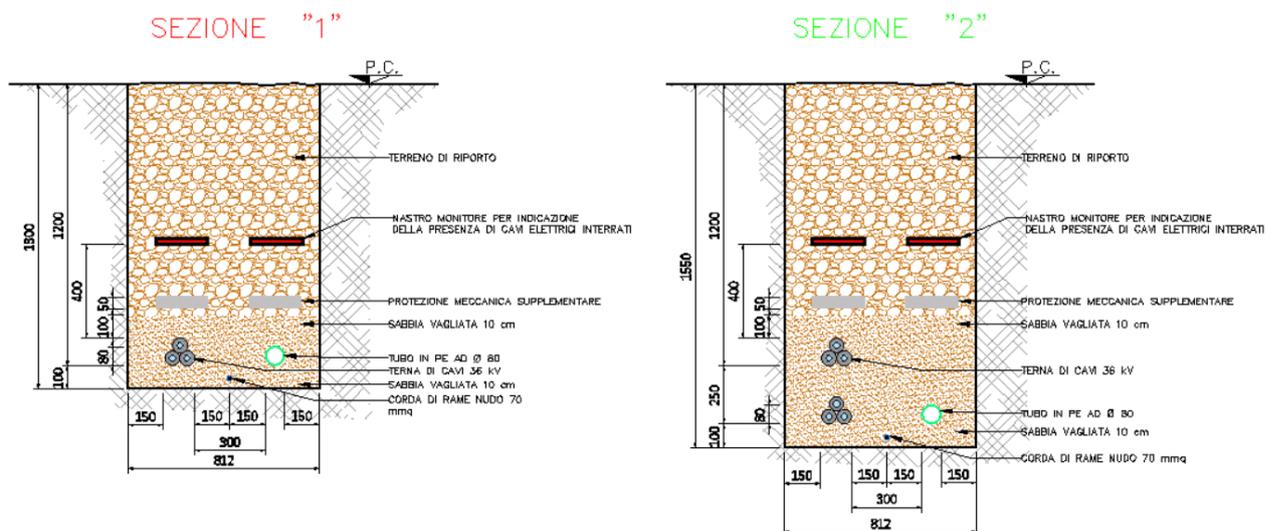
sezioni tipo cavidotto (rosso=1 terza; verde=2 terne)
